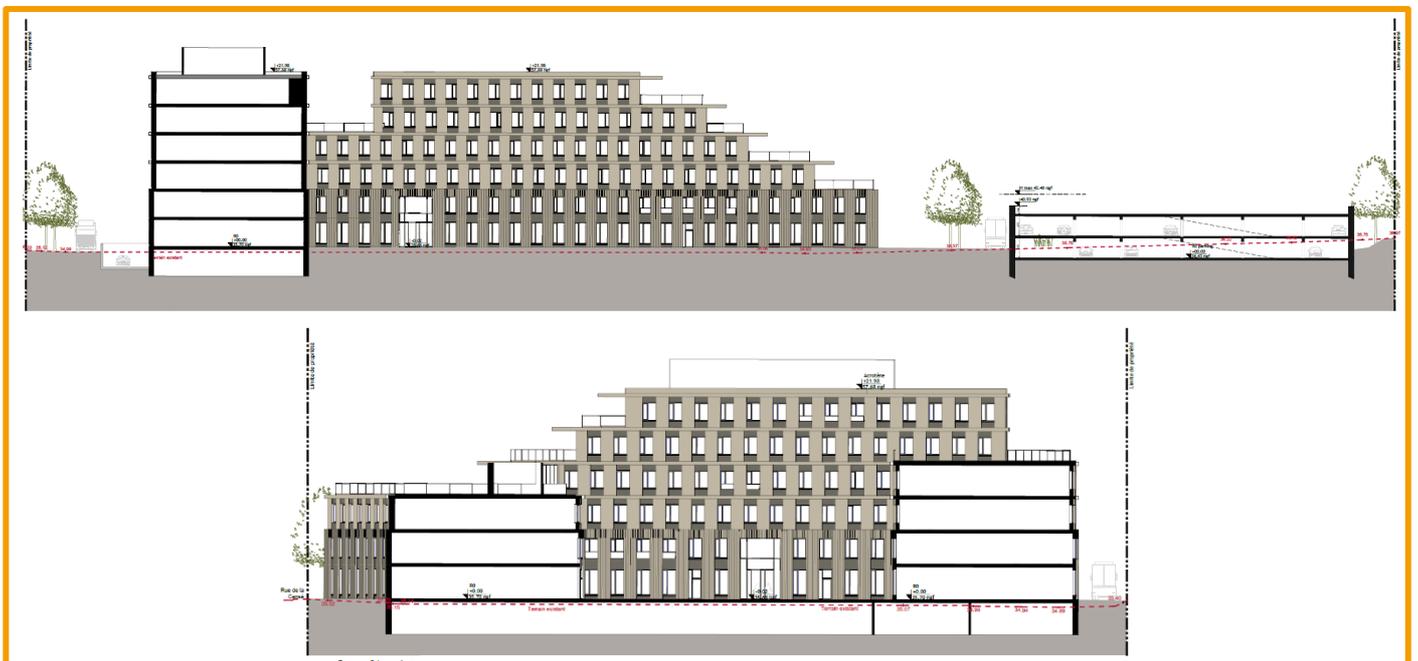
Plan de coupe du projet d'aménagement (source : ADIM en date du 23/06/2023)
